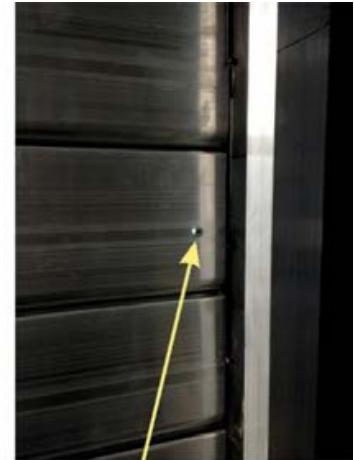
б – Примеры винтовых и болтовых креплений.
